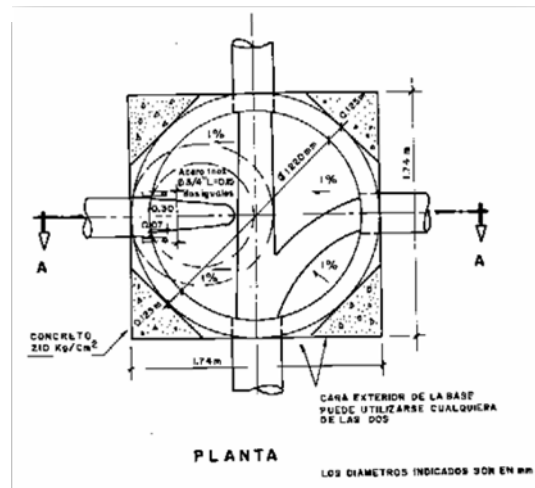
Planta Boca de Visita tipo Ia⁷
